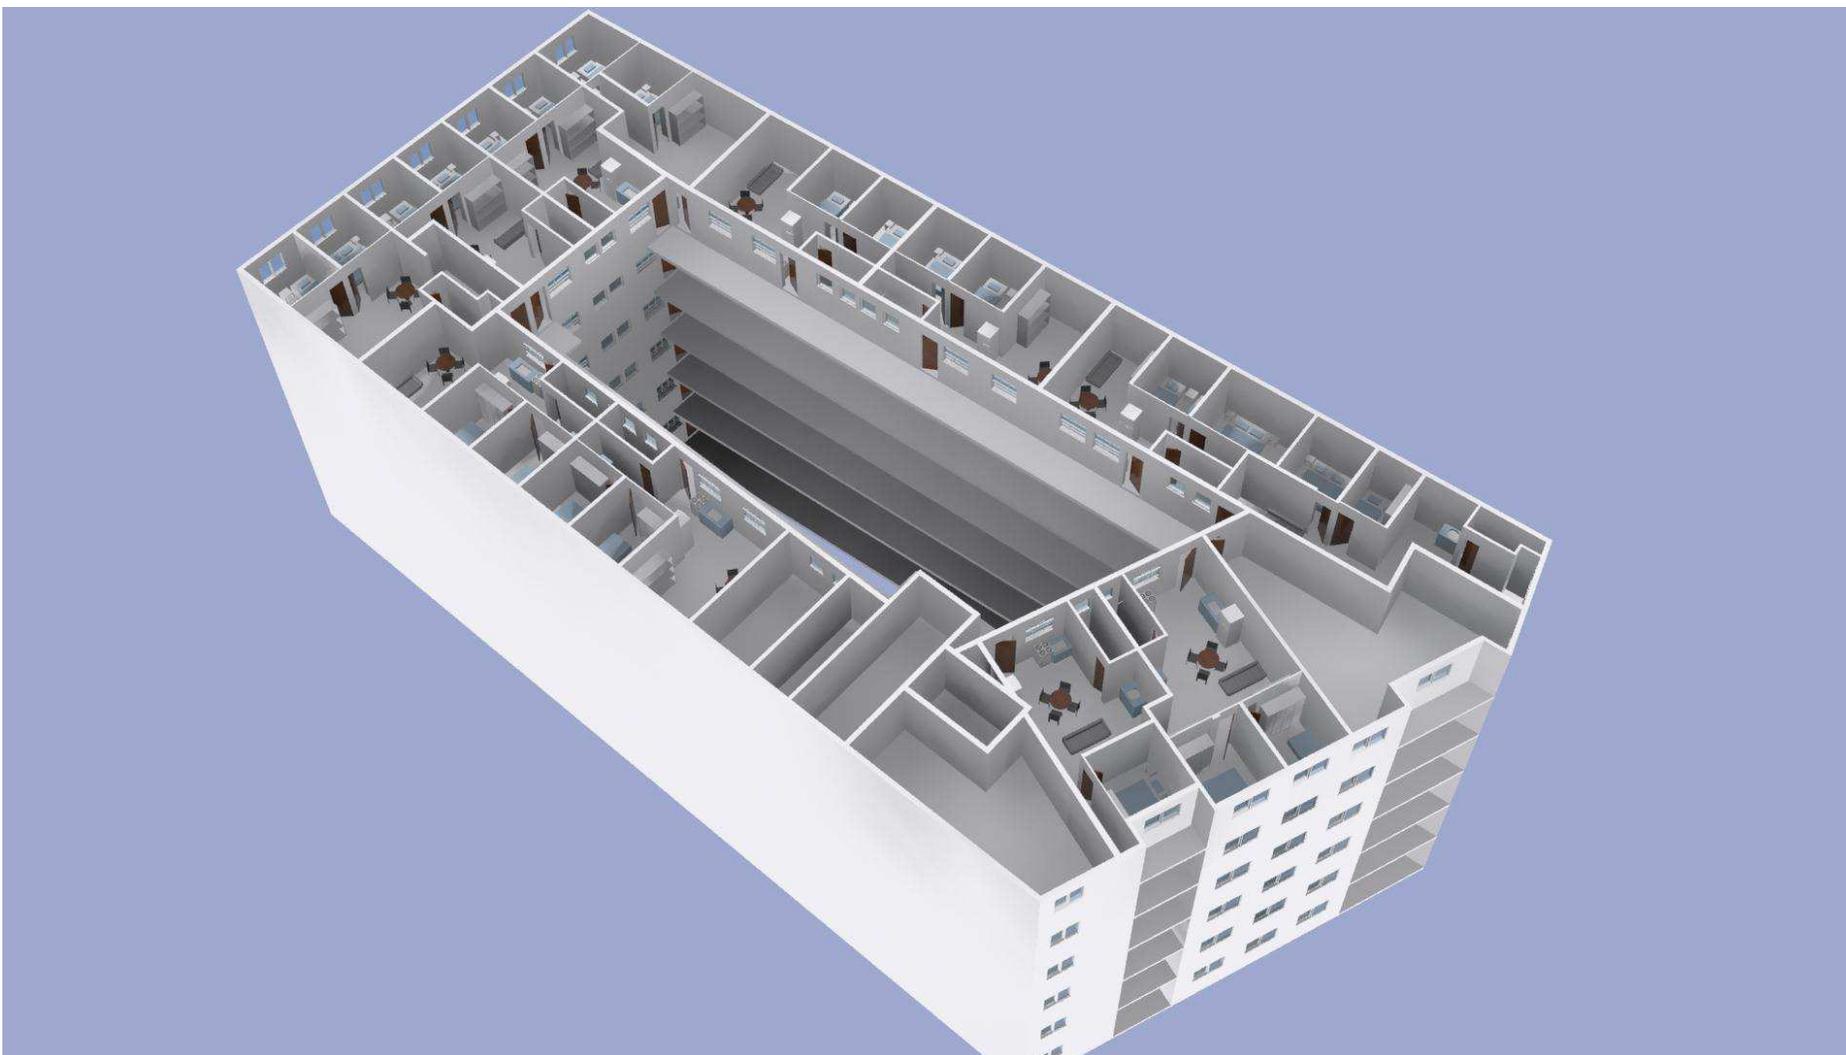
vista 3D do prédio. Vista da fachada frontal.
